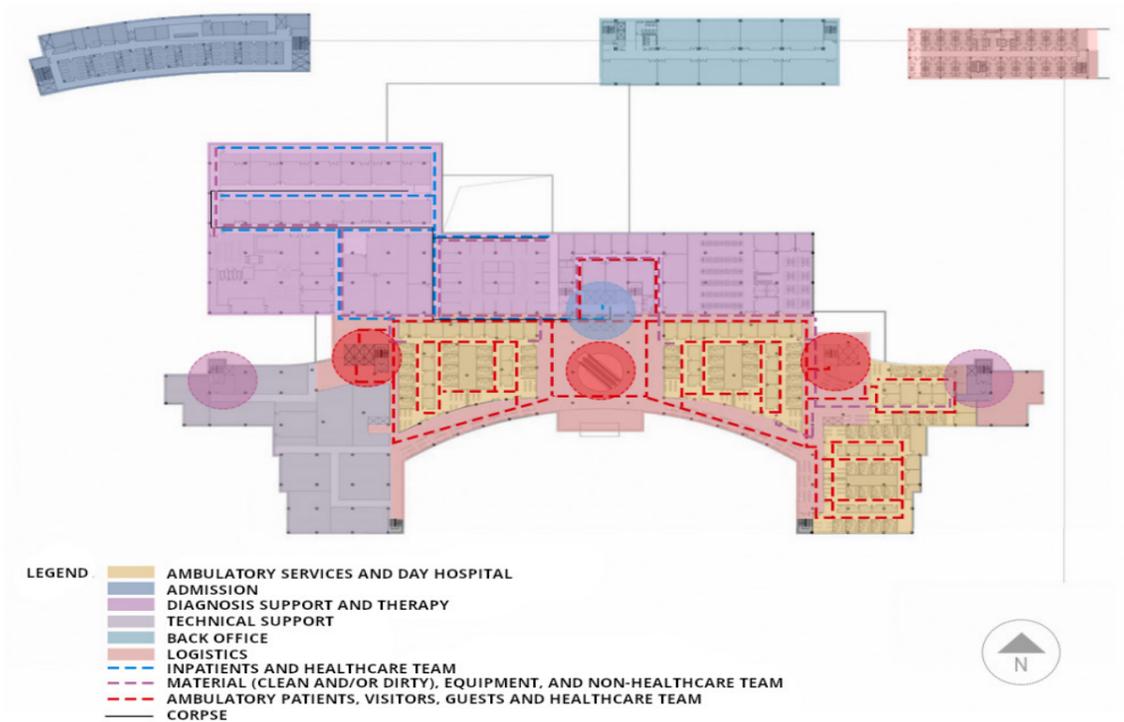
Schema delle funzioni e dei collegamenti del Piano primo dell'ospedale
